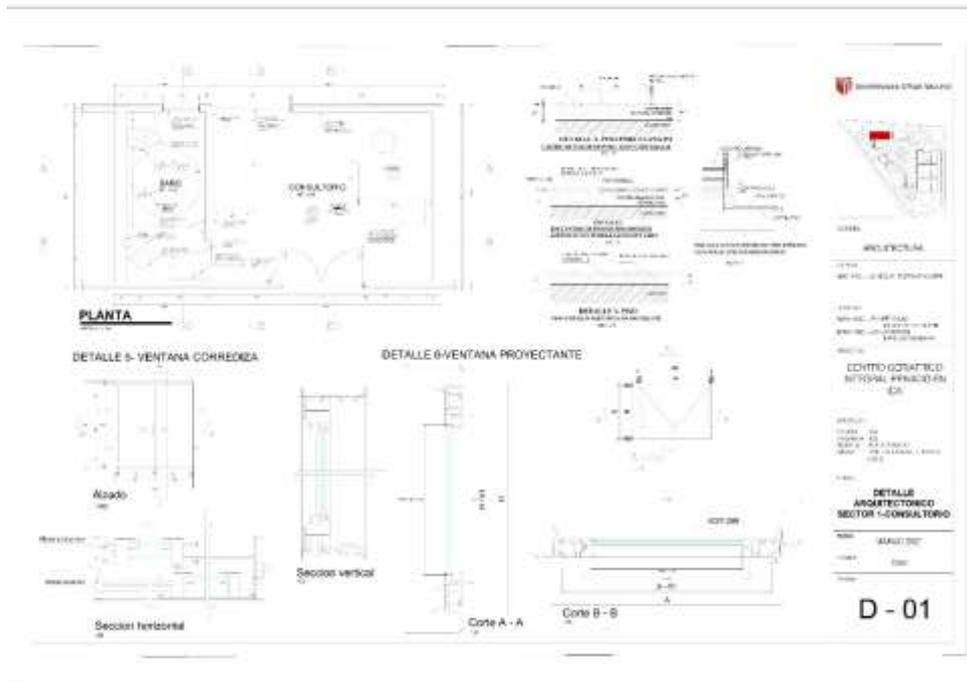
Plano Detalles Arquitectónicos de Consultorio
